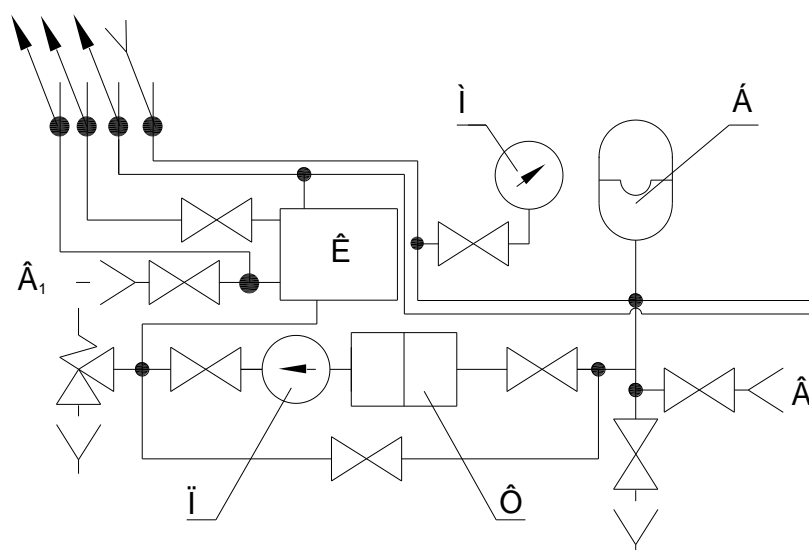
Схема теплового пункту для системи водяного опалення та ГВП будинку
